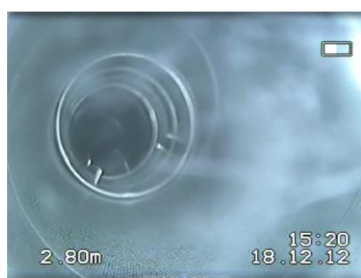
Inspection des conduits d'extraction de l'air des salles de bains
